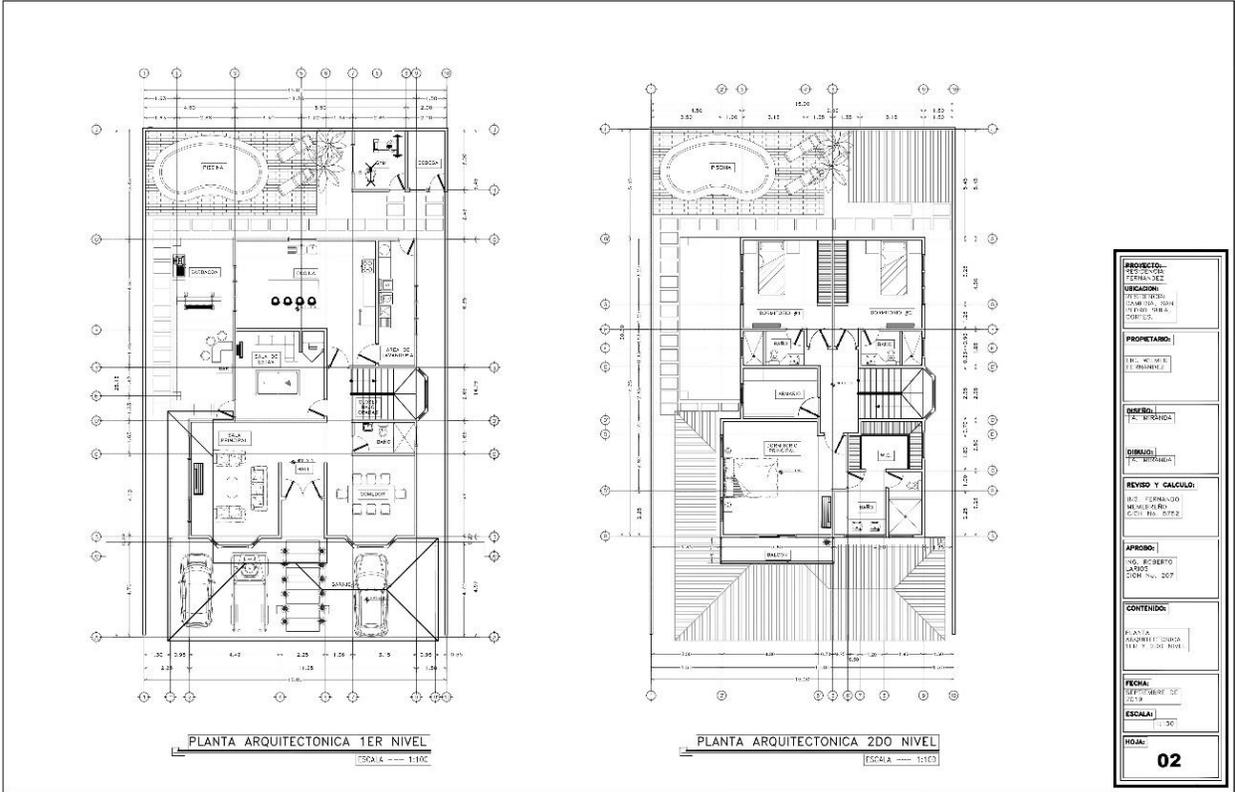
Plantas Arquitectónicas, Residencia Wilmer Fernández
